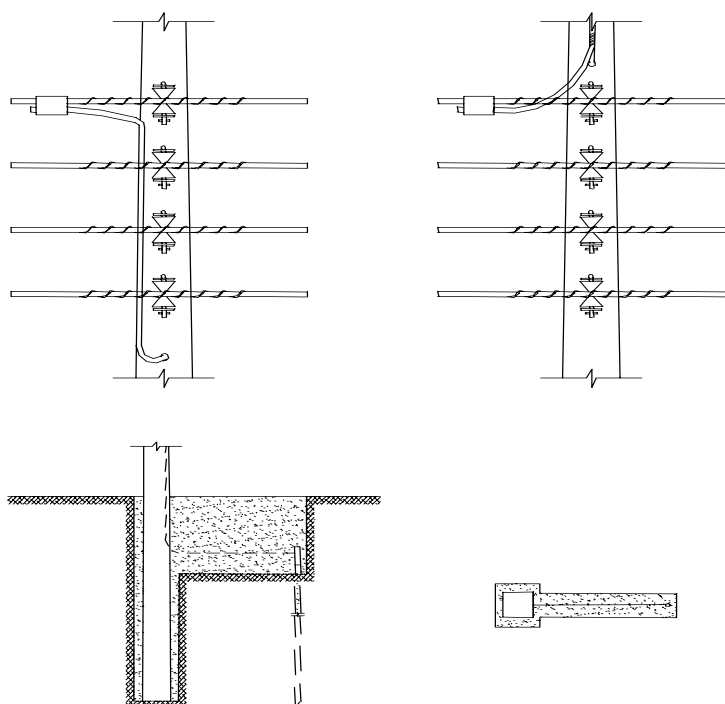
Aterramento de rede secundária (estrutura em alinhamento)
